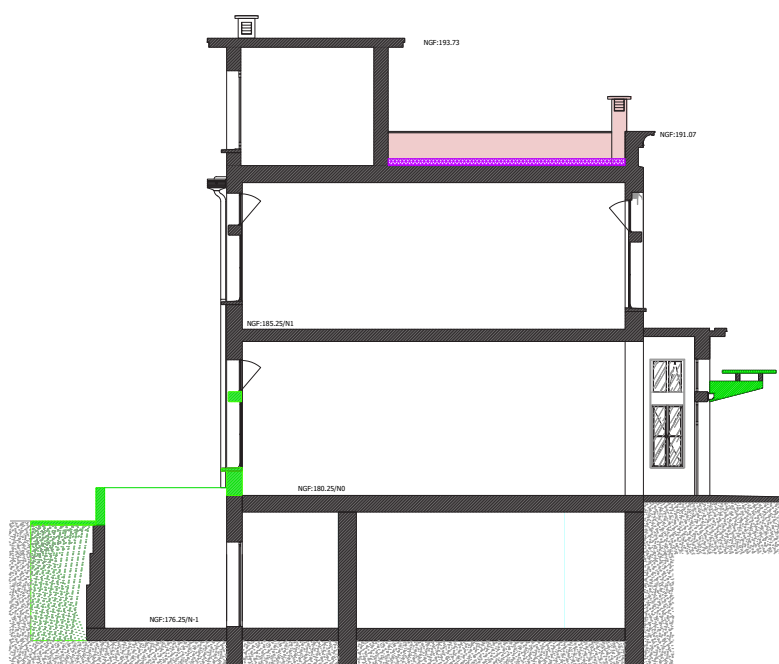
État projeté (APD) du lot Gros-œuvre - maçonnerie - pierre de taille, coupe-élévation F (ouest), pavillon A, Agence Goutal, 2024.
